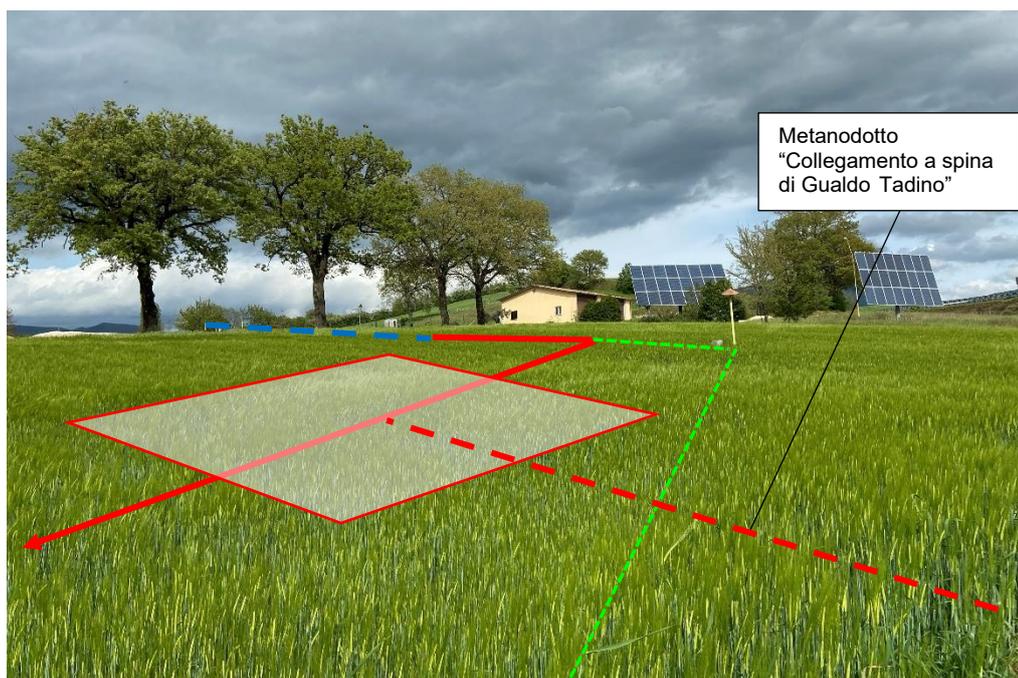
Stacco Metanodotto “Collegamento impianto 4105755/6 Località Crocicchio con area trappola di Gubbio DN 400 (16”), DP 75 bar”, e impianto PIDI in progetto
